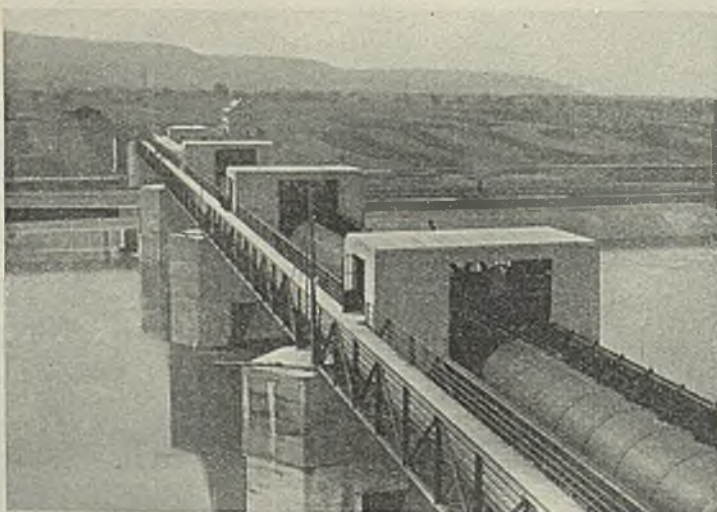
Staustufe Kleinwallstadt. Blick vom Dach des Krafthauses auf die Wehranlage.
